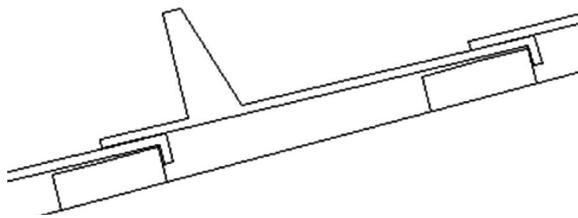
Verstärkte Ausführung mit Brett (unten)
